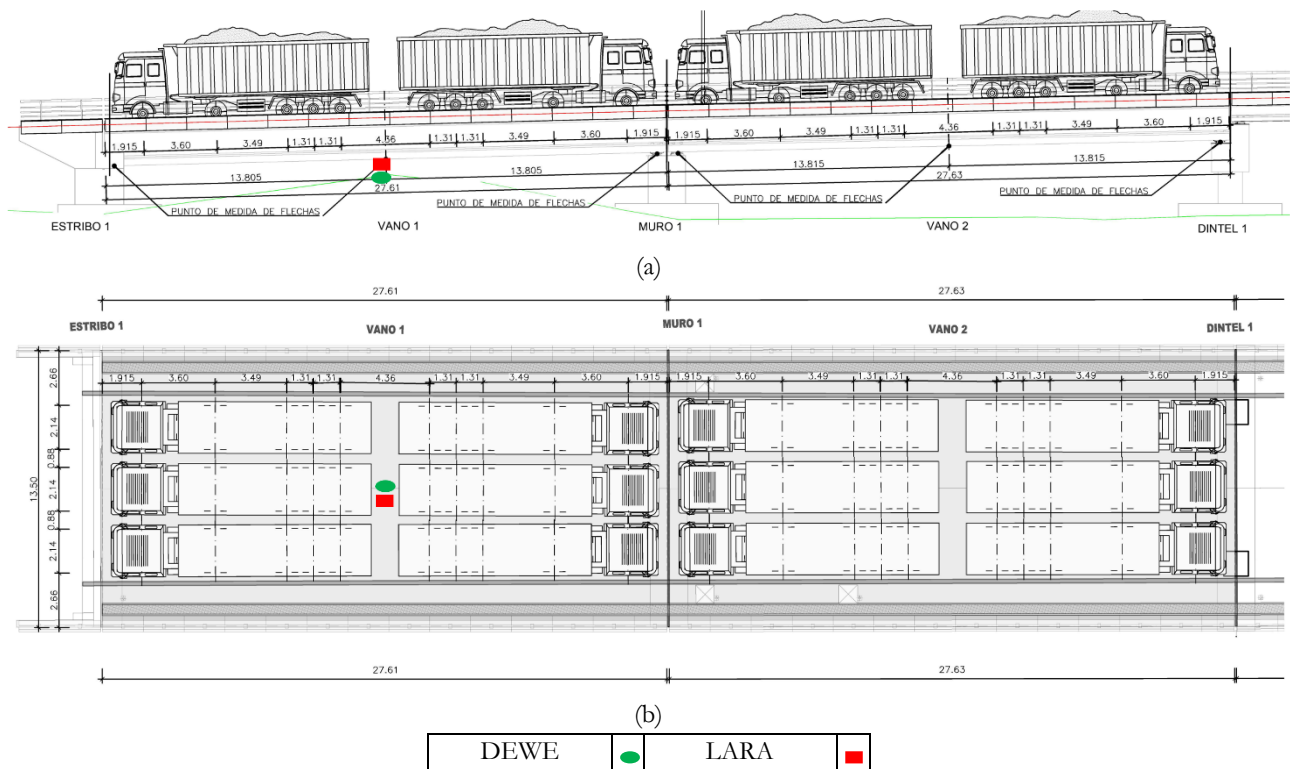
Ubicación de los sensores. a) Sección longitudinal y b) Planta del puente en estudio.
